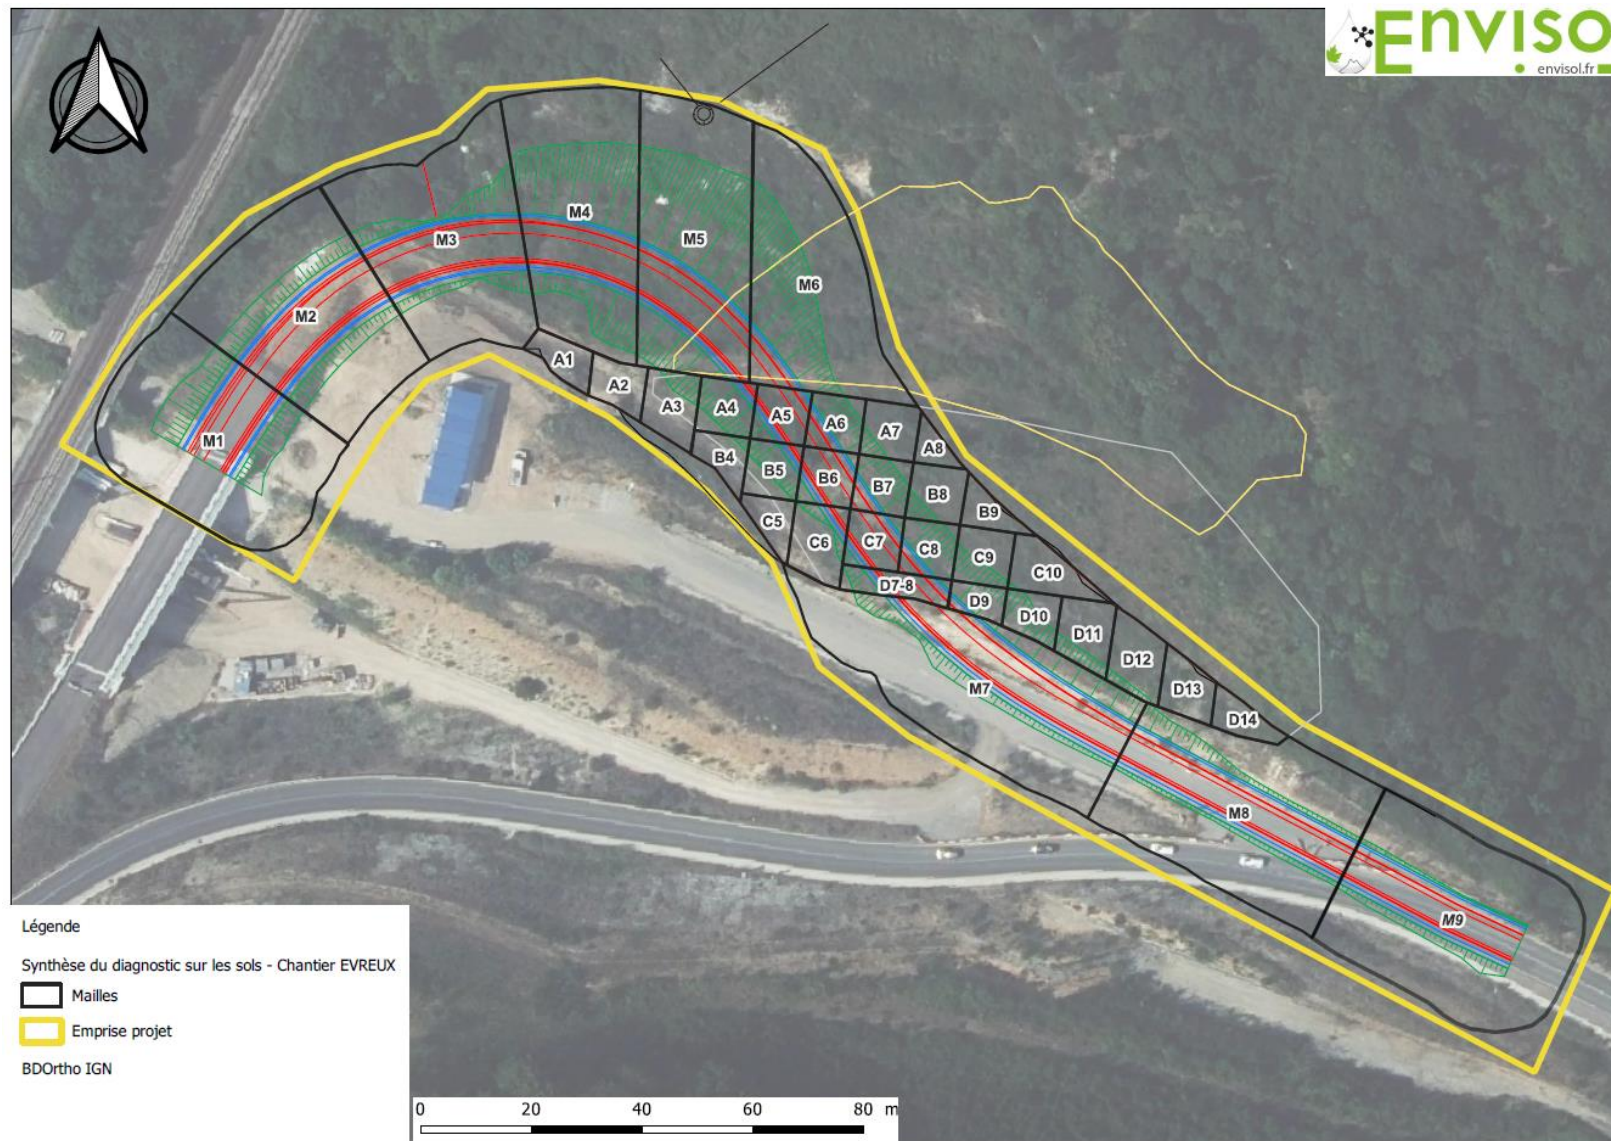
Emprise du site sur photographie aérienne et sur fond de plan de projet (tracé de la déviation).
